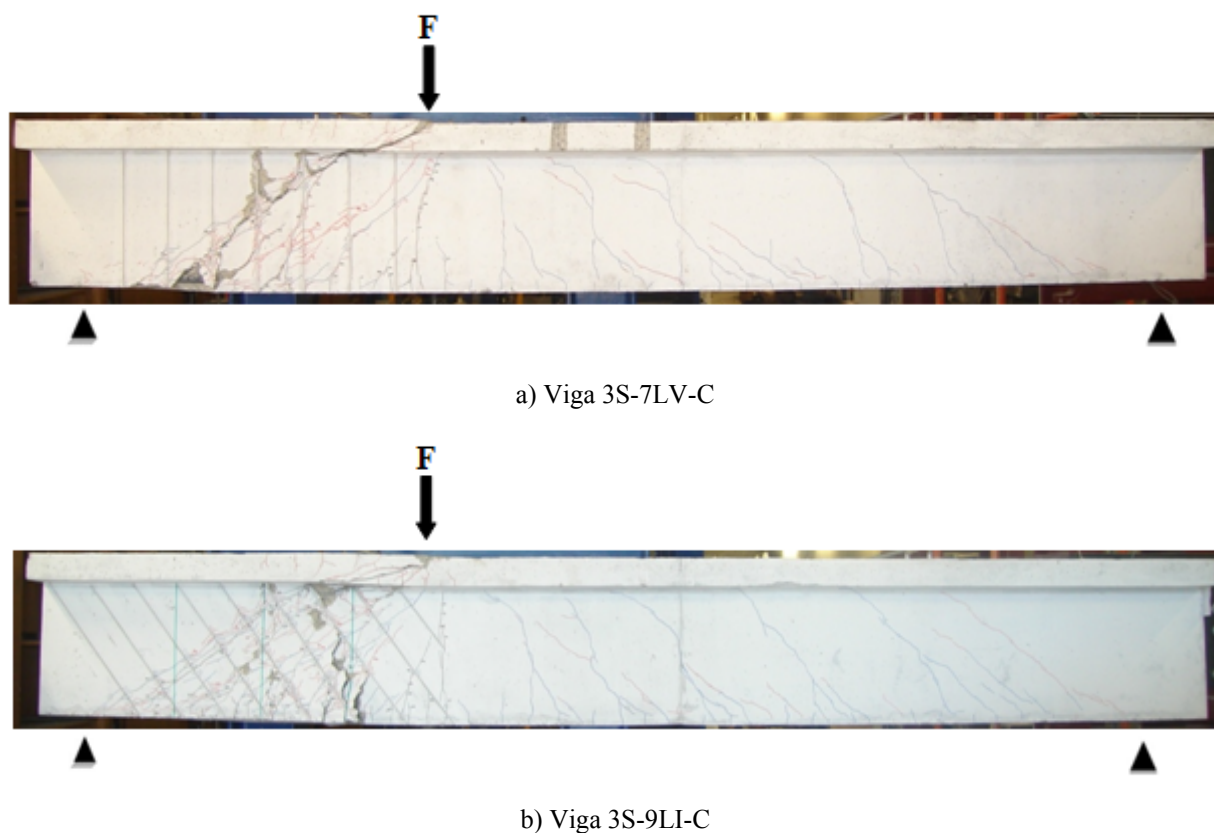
Padrão de fendilhação instalado nas vigas 3S-7LV-C e 3S-9LI-C (face da frente).
